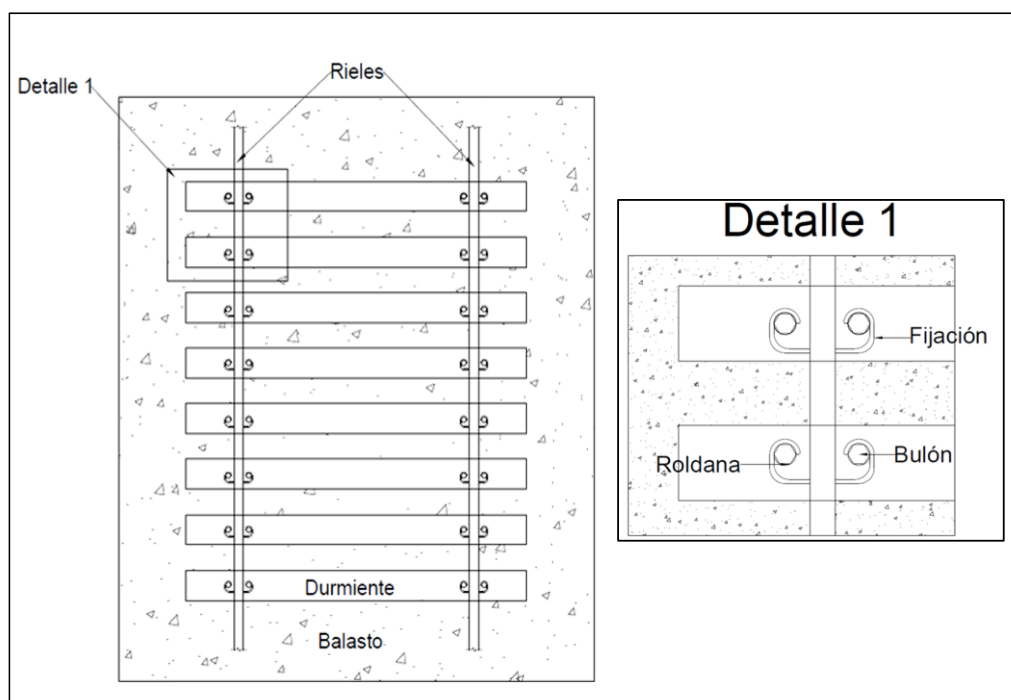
Vista en planta de la superestructura ferroviaria. Fuente: Elaboración propia. (10/04/2019).
